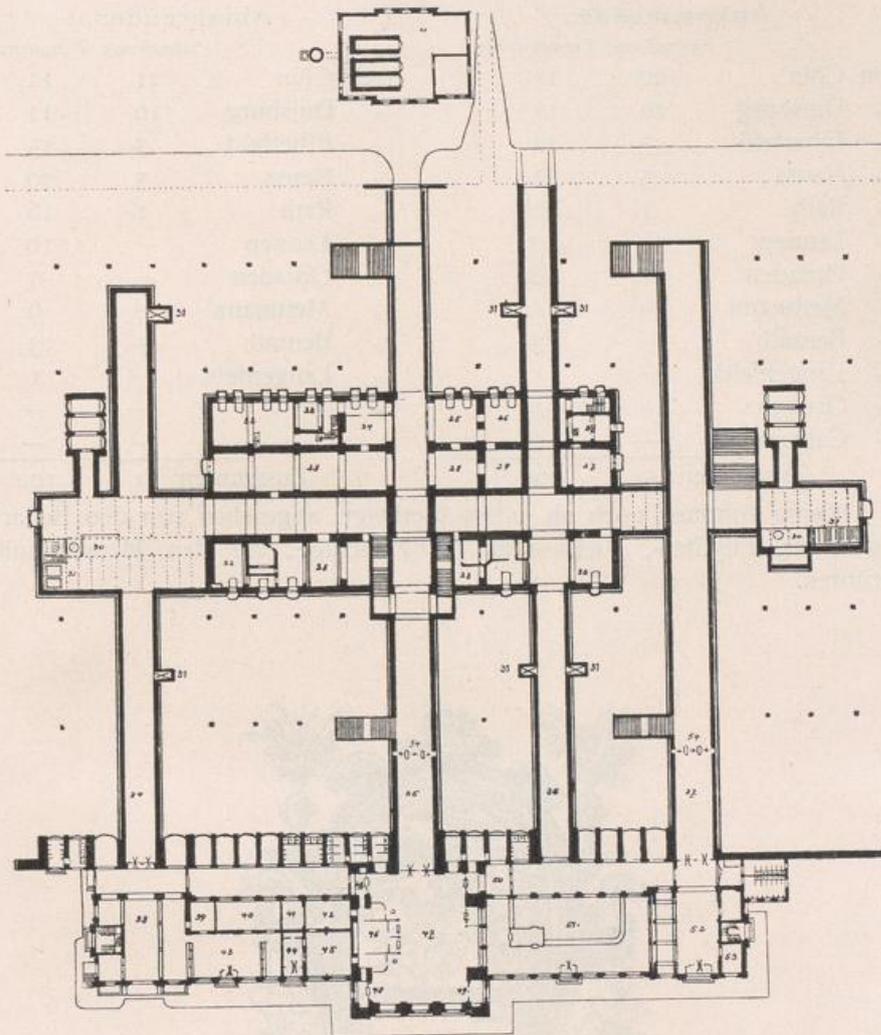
Hauptbahnhof. Grundriss des Vorplatzgebäudes. 1:1280.
